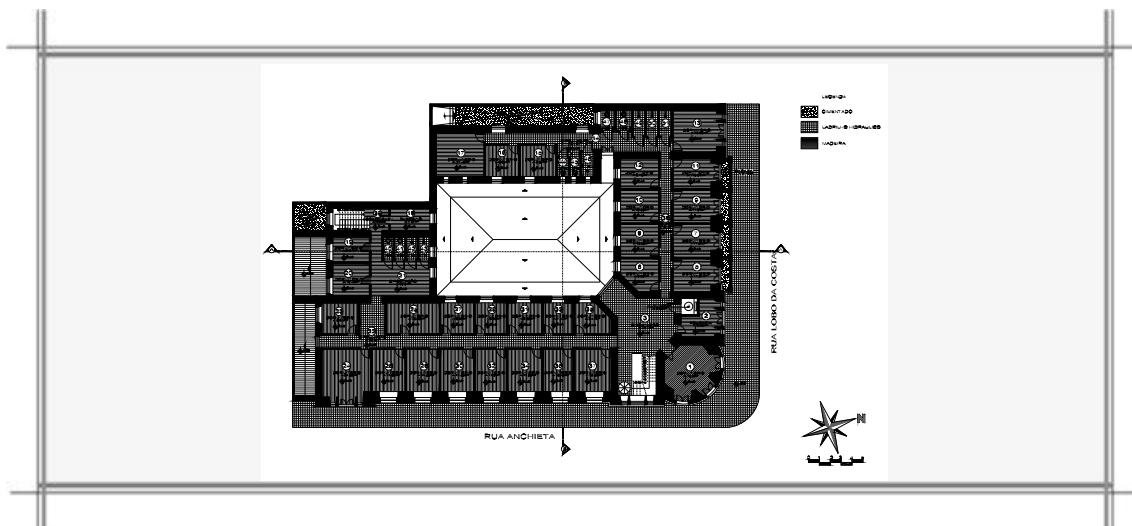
Planta Baixa do 4º Pavimento. Desenho: Cristiane Müller.
